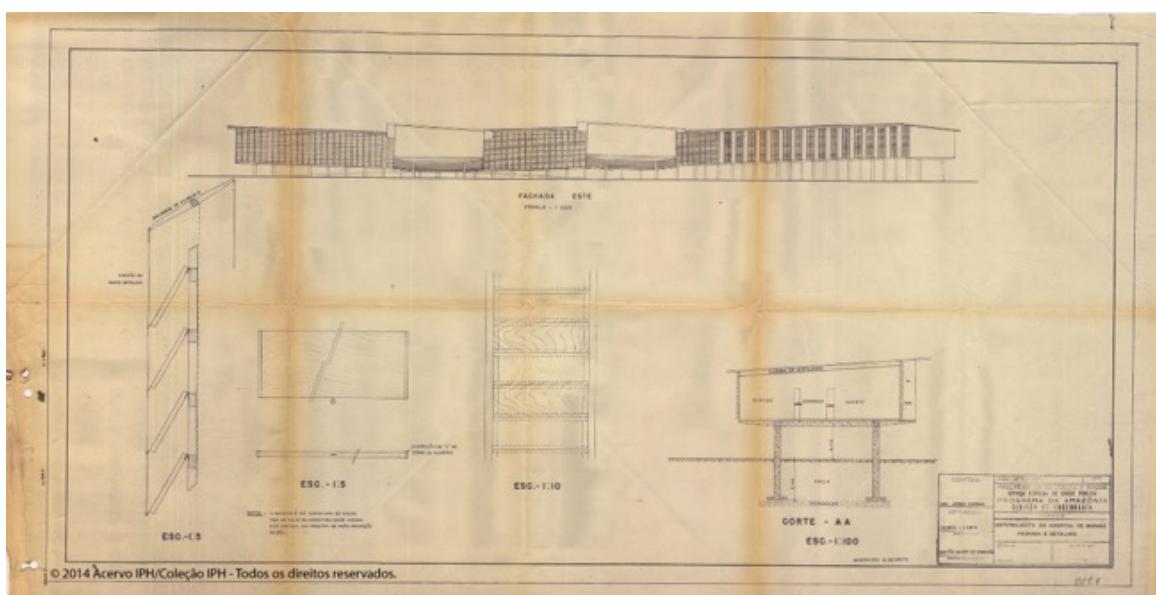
Planta con alzado, corte y detalles de la primera versión del Hospital de Marabá
